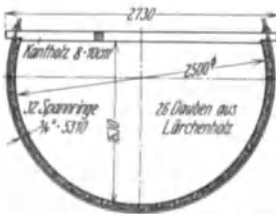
Holzdaubengerinne Mylau i. V. (Bautechn. 1928.)
